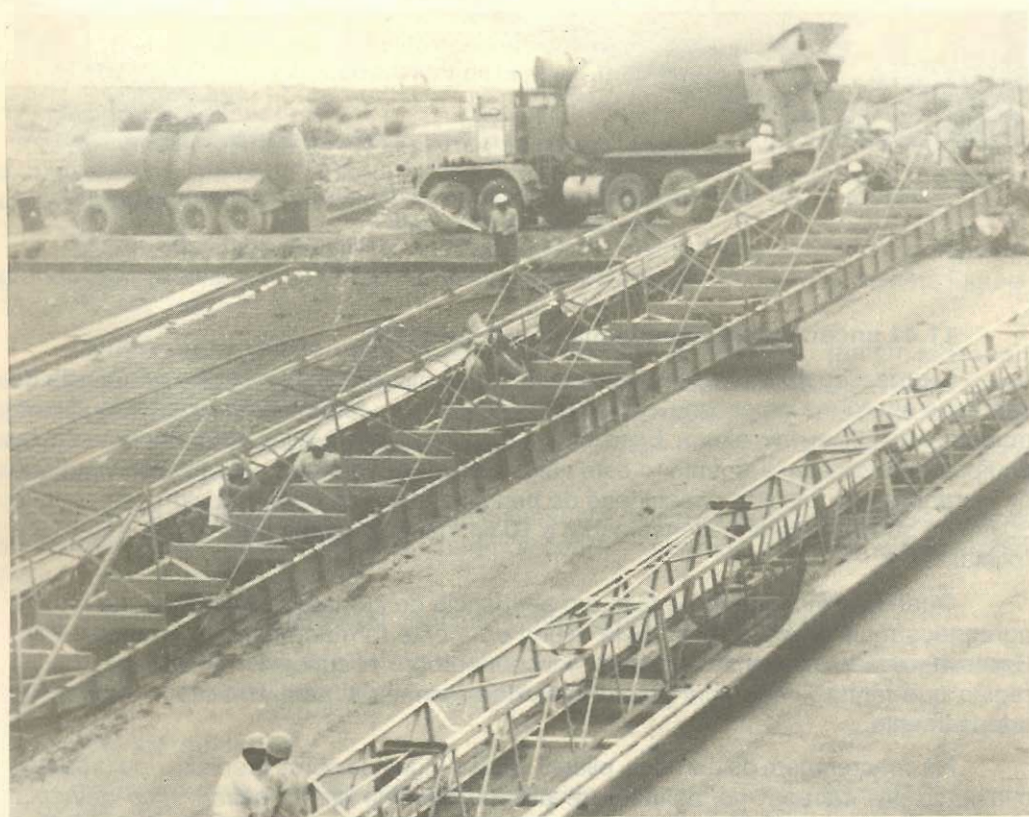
Vibro-acabadora efetuando lançamento do concreto em obra de canais
